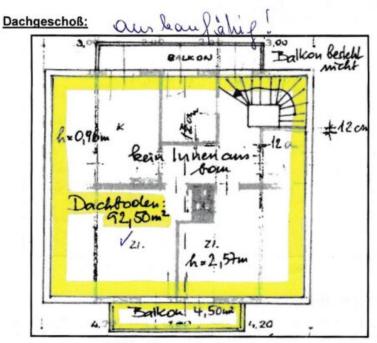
Grundrissplan Dachgeschoß
